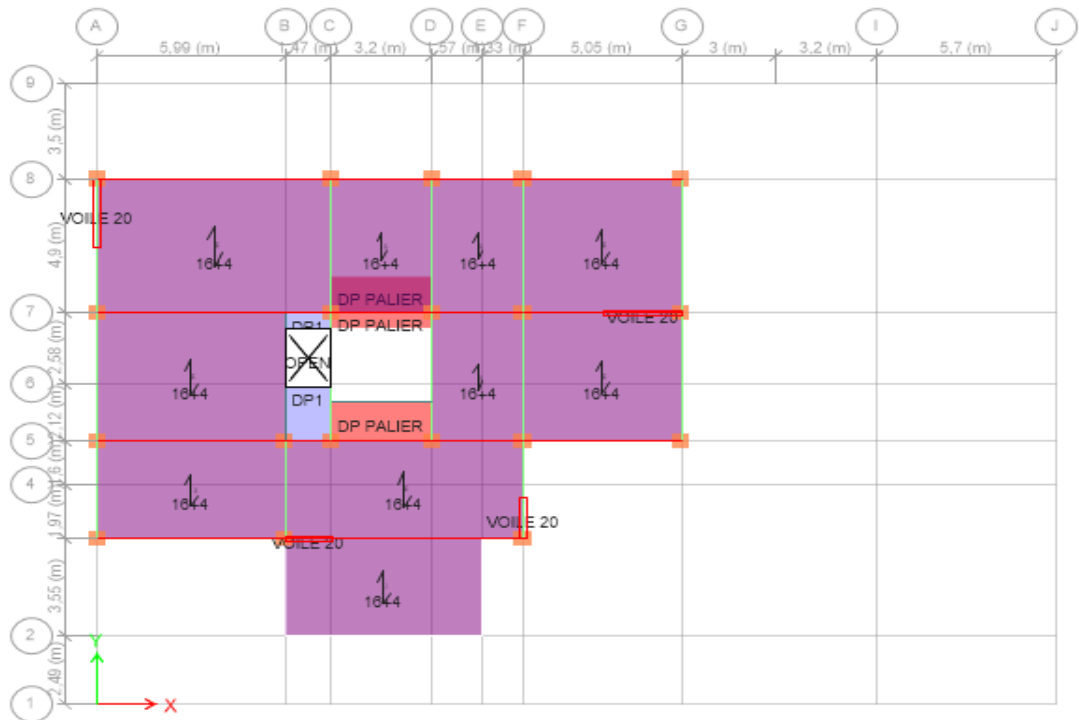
Schéma de la disposition des poutrelles pour le dernier niveau
